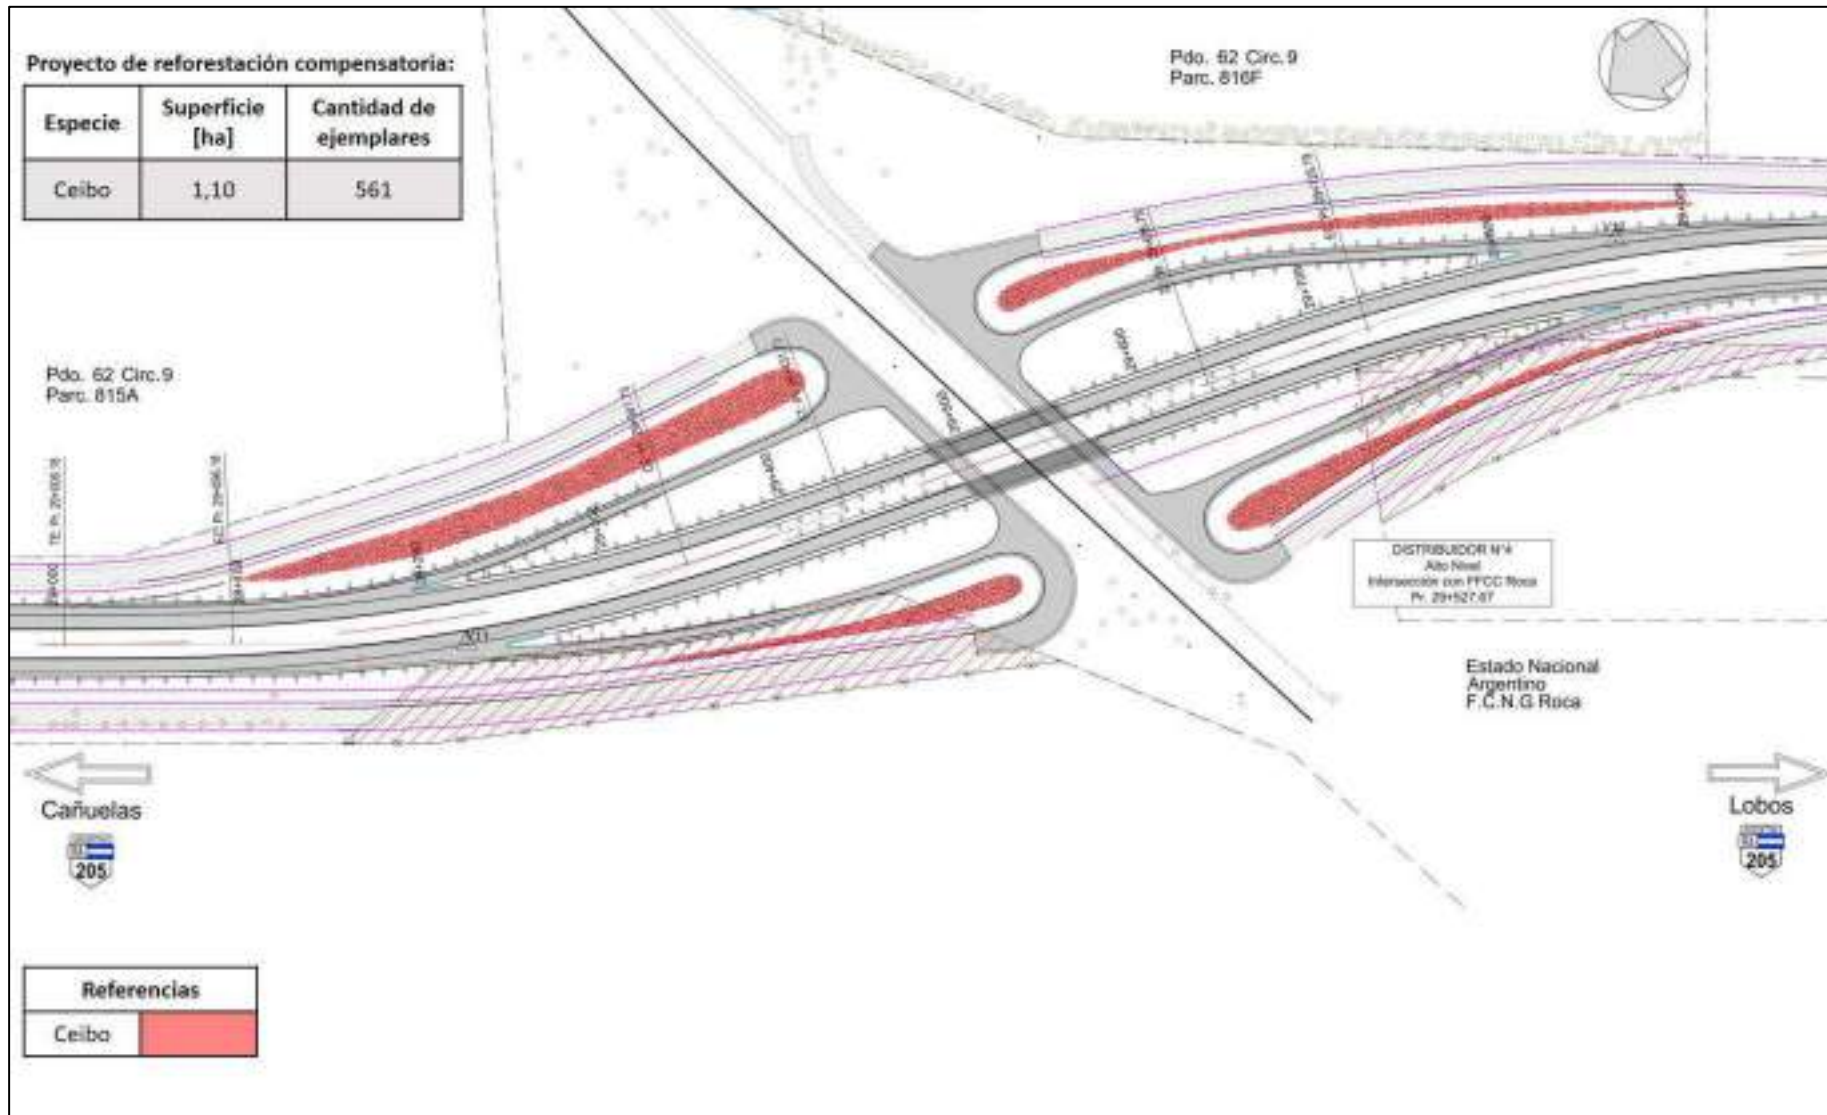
Proyecto de reforestación compensatoria Zona Acceso Lobos
